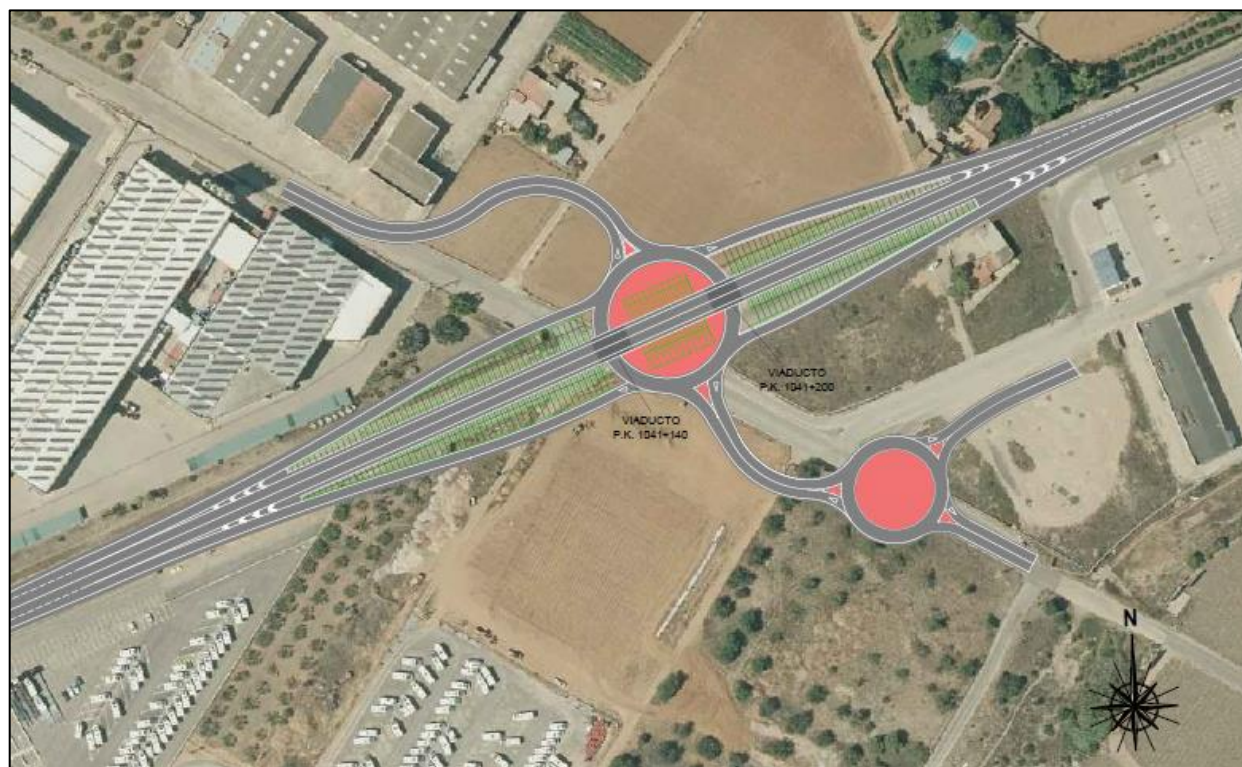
Imagen en planta con la solución proyectada. Fuente: elaboración propia.
